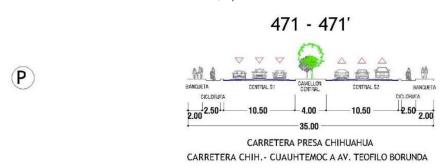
Sección vial propuesta Carretera Presa Chihuahua. Fuente: PDU 2040.
